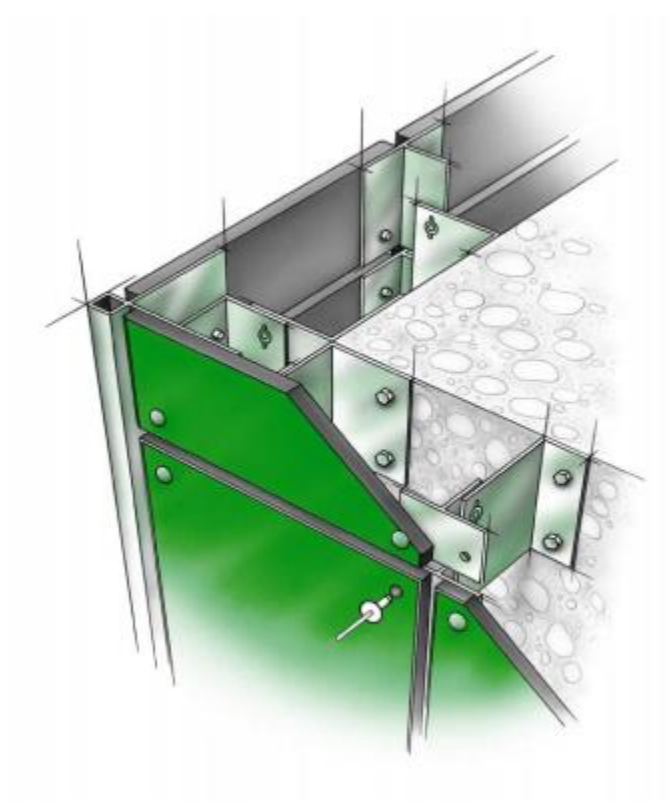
Coupe horizontale d'une fixation de panneau avec rivets
